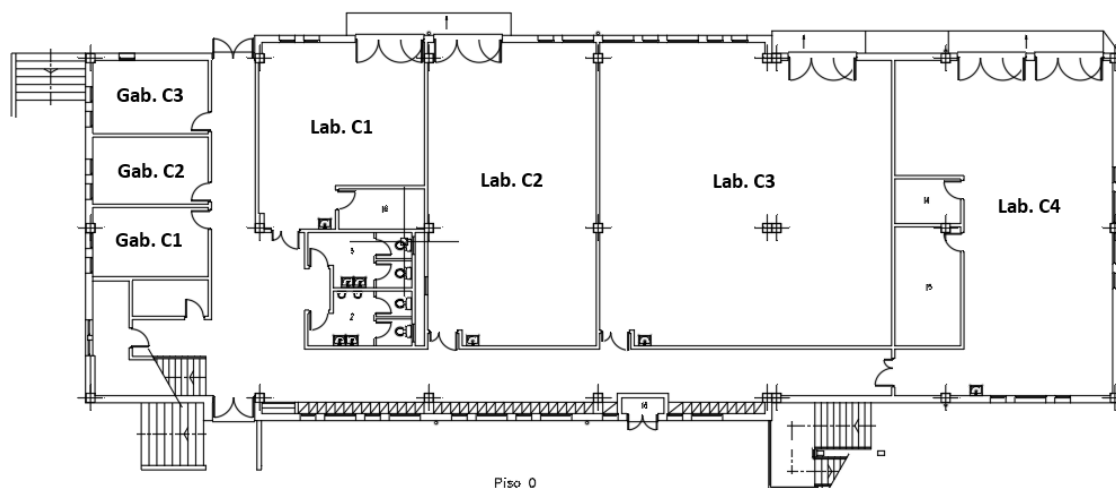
Planta do piso 0 do Bloco C da ESTCB.
